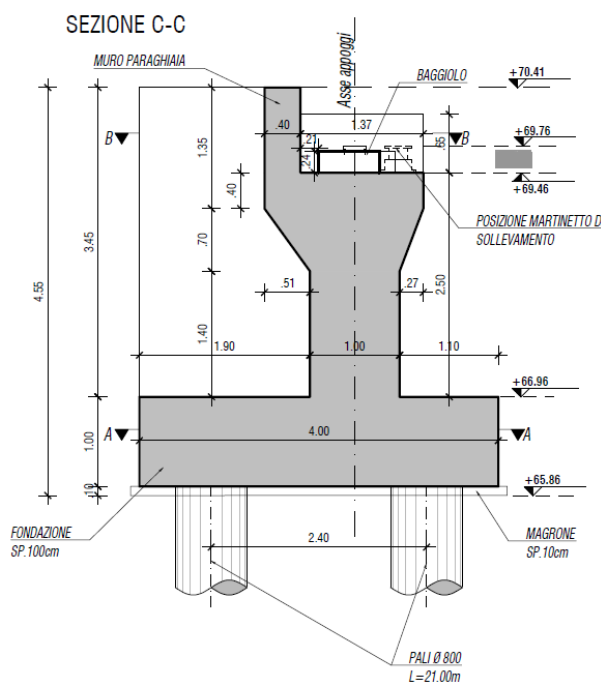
Sezione ortogonale di carpenteria spalla.
